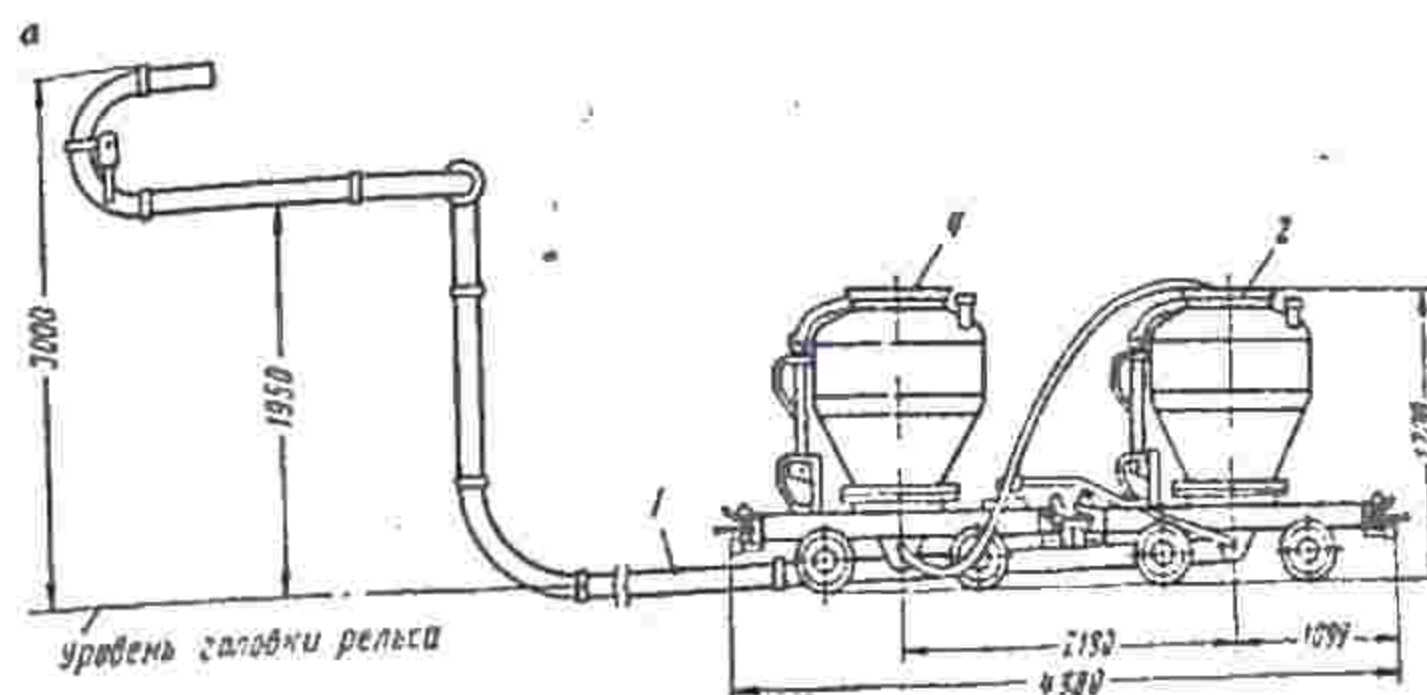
Комплекс для бетонирования горных выработок УБ-1
